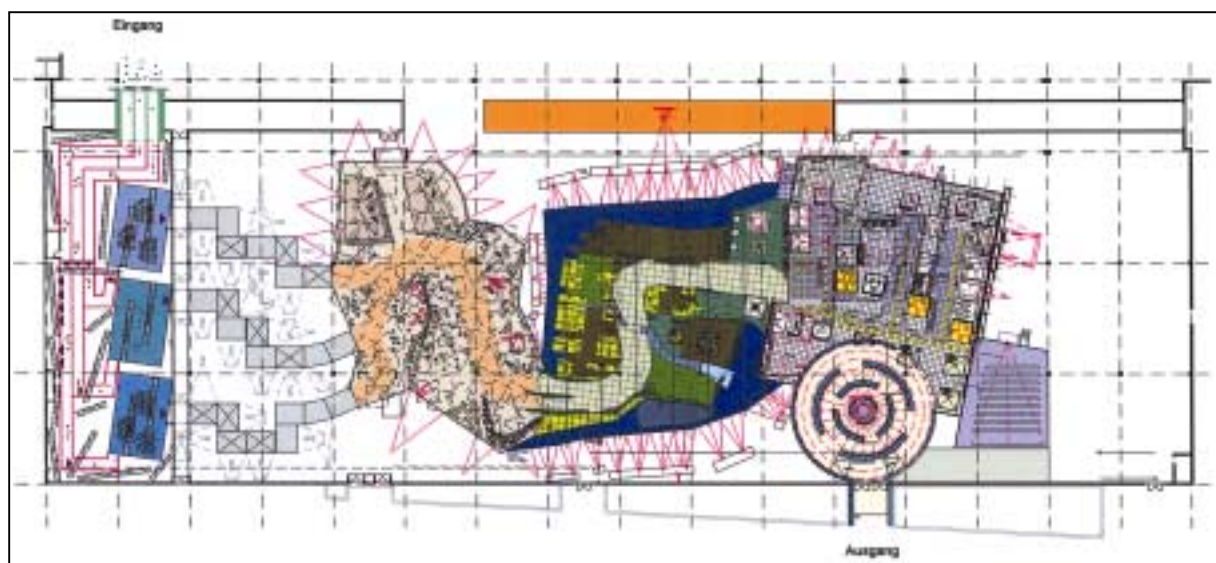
Grundriss des Themenparks „Umwelt: Landschaft, Klima“
